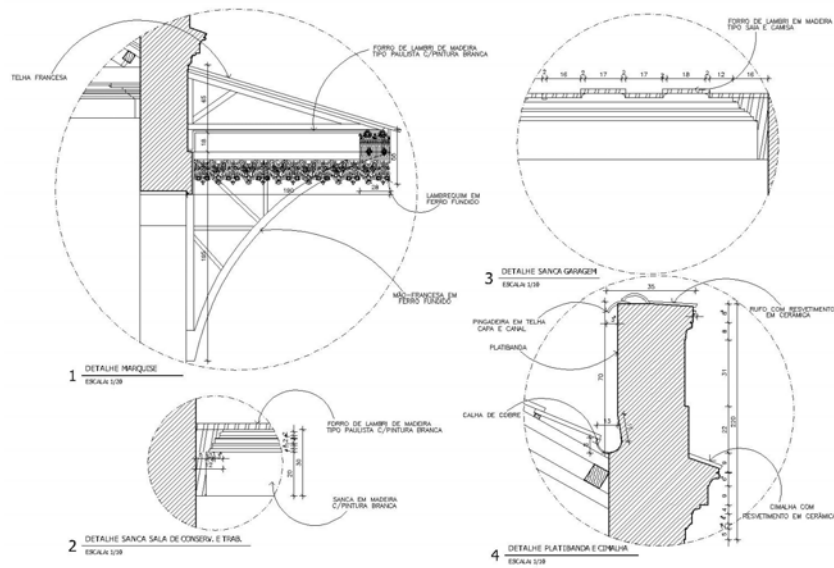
Exemplo de detalhes construtivos encontrados em telhados. Projeto de restauração de telhado da Garagem da Casa de Rui Barbosa, Botafogo, Rio de Janeiro, RJ. Fonte: Arquivo Bk Arquitetos Ltda.
